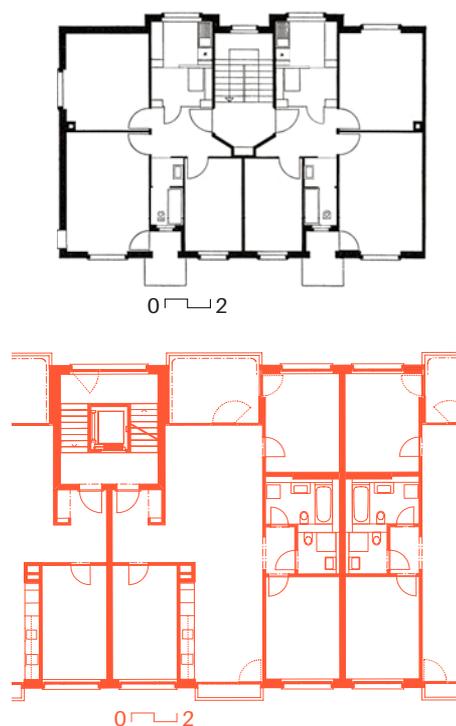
Aperçu avant/après des plans du lotissement Triemli
